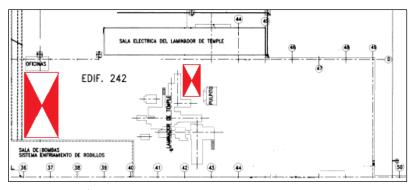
Áreas de precaución al instalar maquinaria o elementos pesados.
